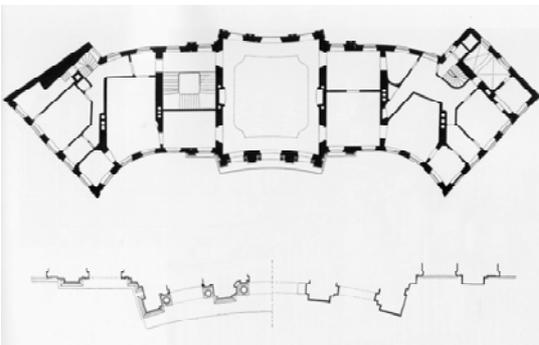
J. C. Schlaun, Erdrostenhof Münster, 1753-57, Grundriss
